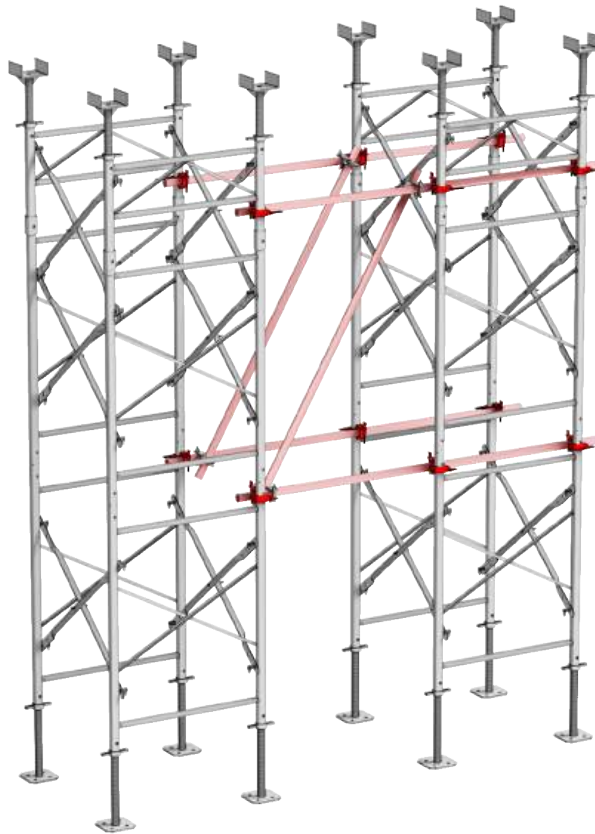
Contraventamento de três pontos com tubos e braçadeiras.
